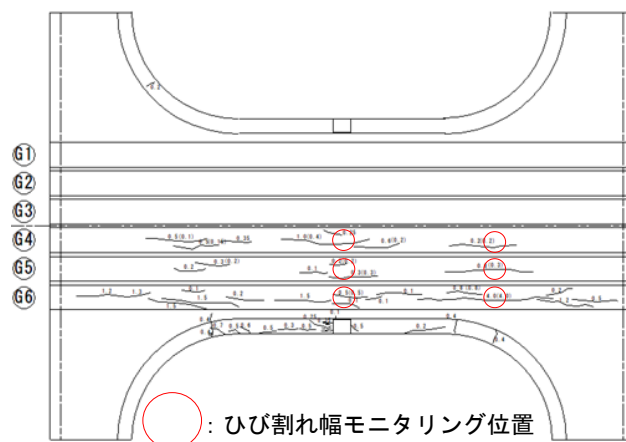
損傷(ひび割れ)図(主桁下面)
